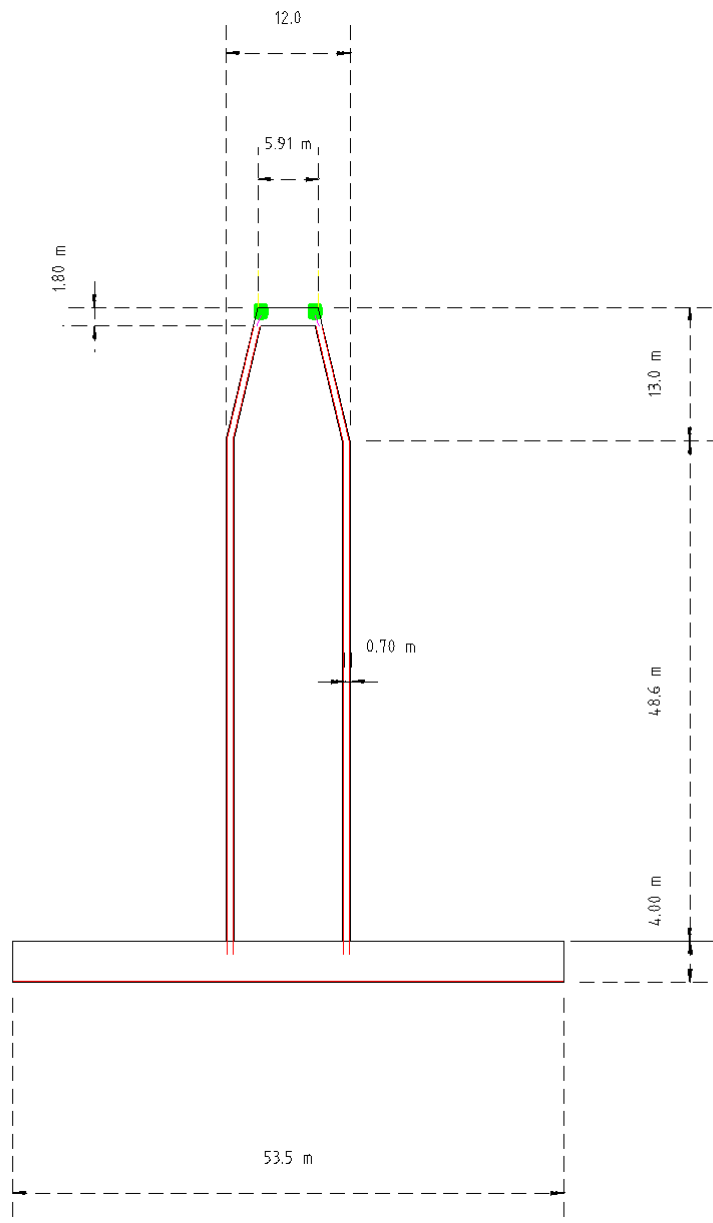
Croquis de la sección longitudinal completa acotada de la cimentación
